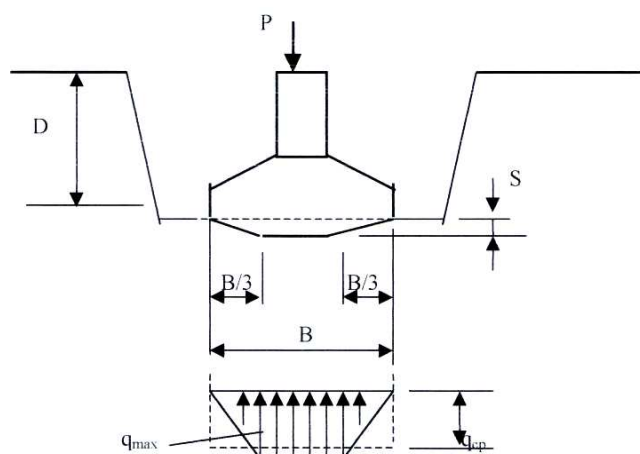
Расчетная схема ленточного фундамента с призматической подошвой.
